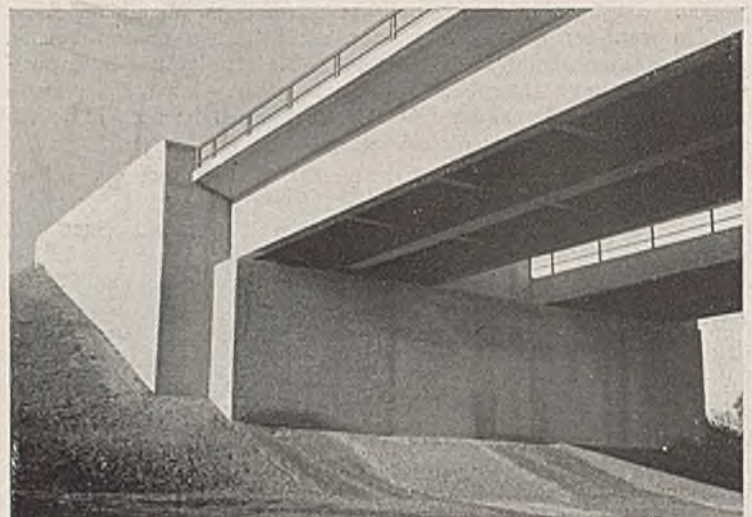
Lange Talbrücke mit Überbauten aus Eisenbetonplattenbalken und mit Widerlagern mit Parallelfügeln.
